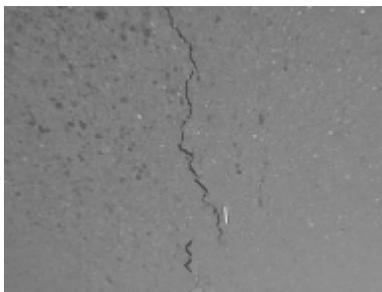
Fisuras transversales y longitudinales en la Calle 38, Cristo Rey.
